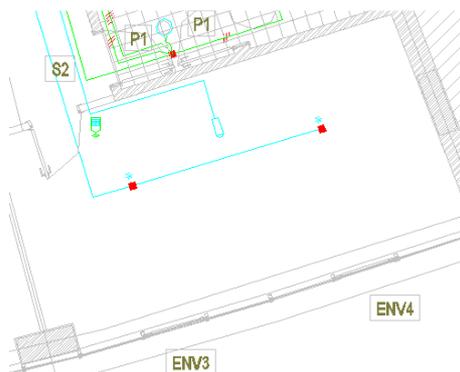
Planta de gabinete individual do edifício em estudo
